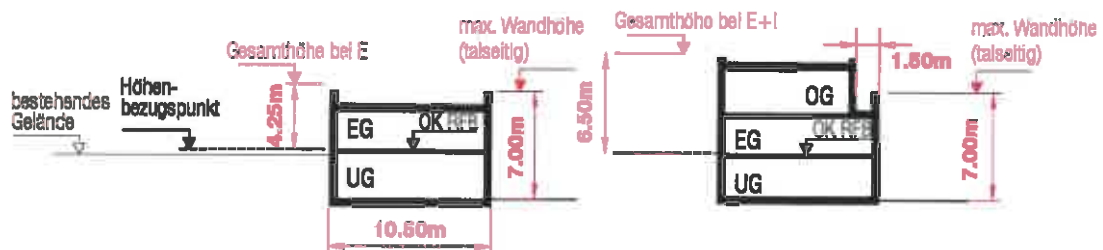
Beispielhafte Gebäudetypen mit Flachdach im WA 2
